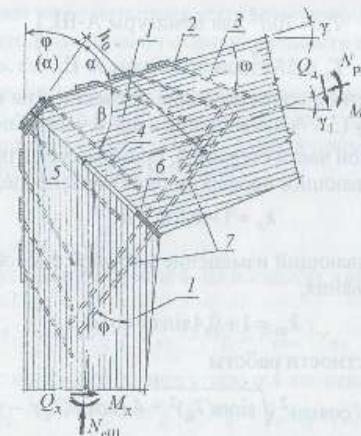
Расчетная схема карнизного узла рамы на вклеенных стержнях: 1 — клееные блоки ригеля и стойки; 2 — накладка из полосовой стали; 3 — армтурные стержни, вклешенные под углом α ; 4 — стержни, вклешенные под углом β ; 5 — стяжные пакеты 2 в случае выполнения рамного узла монтажным; 6 — пластина кляштевых шайб; 7 — пяты, вклешенные под углом α к волокнам.
